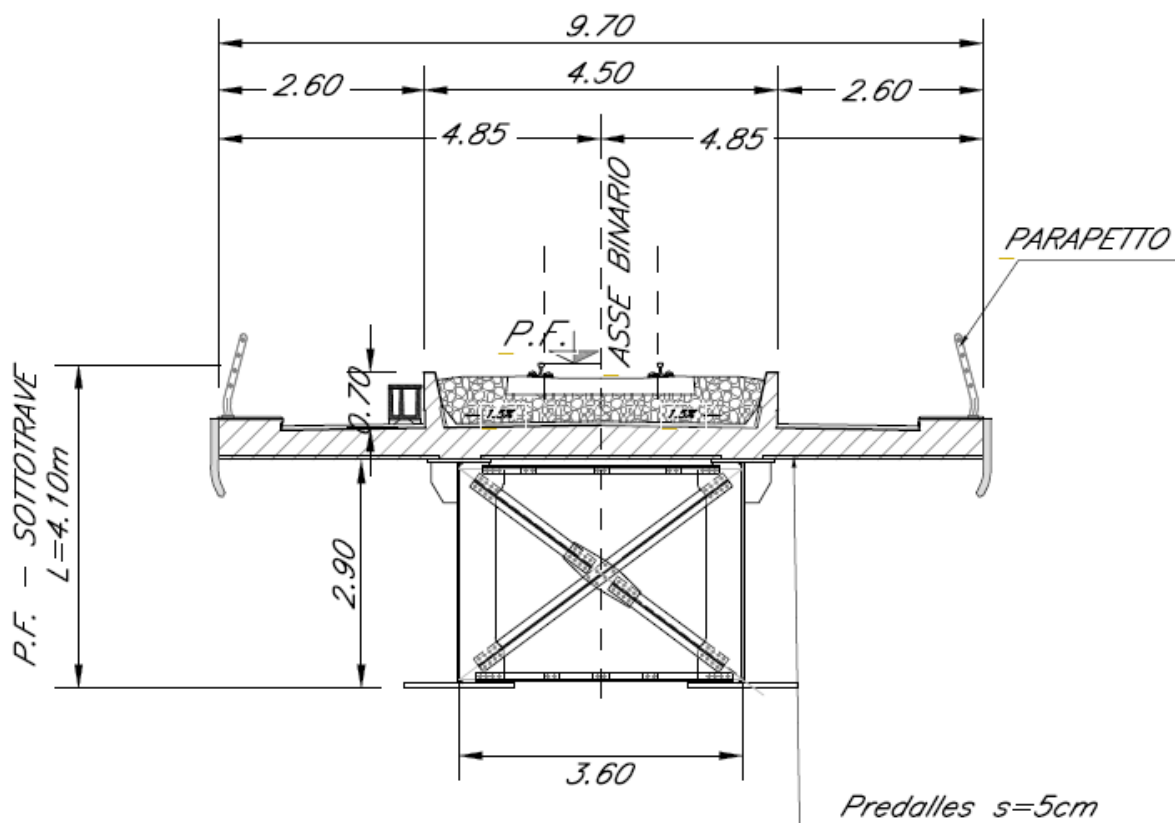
sezione trasversale dell'impalcato misto acc-clc 40m
